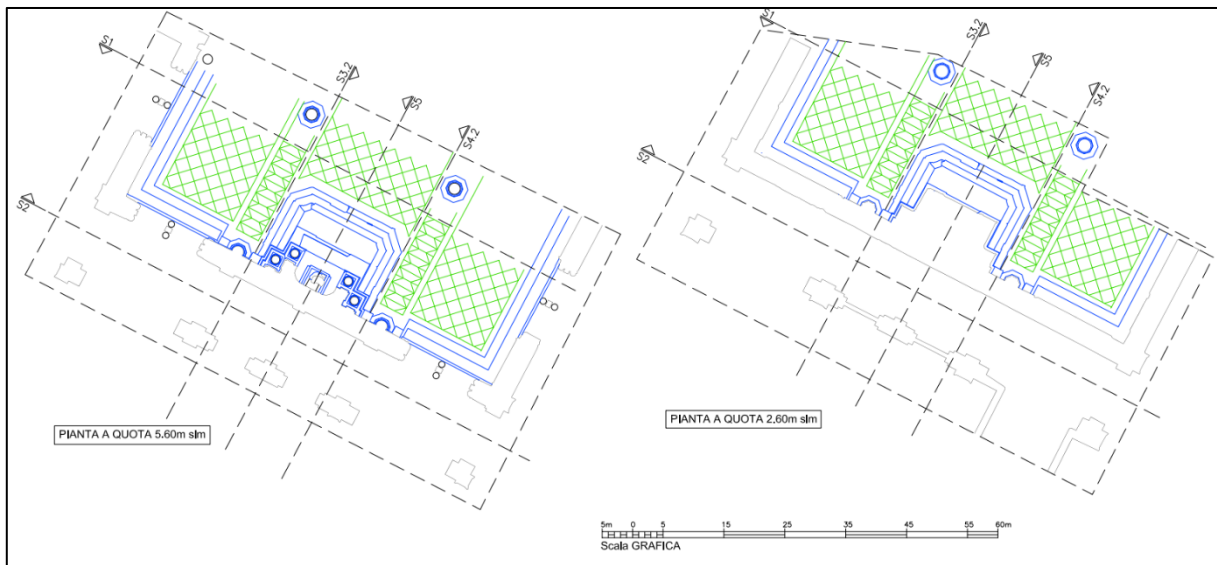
Pianta parete sud – Sezioni orizzontali, vista
